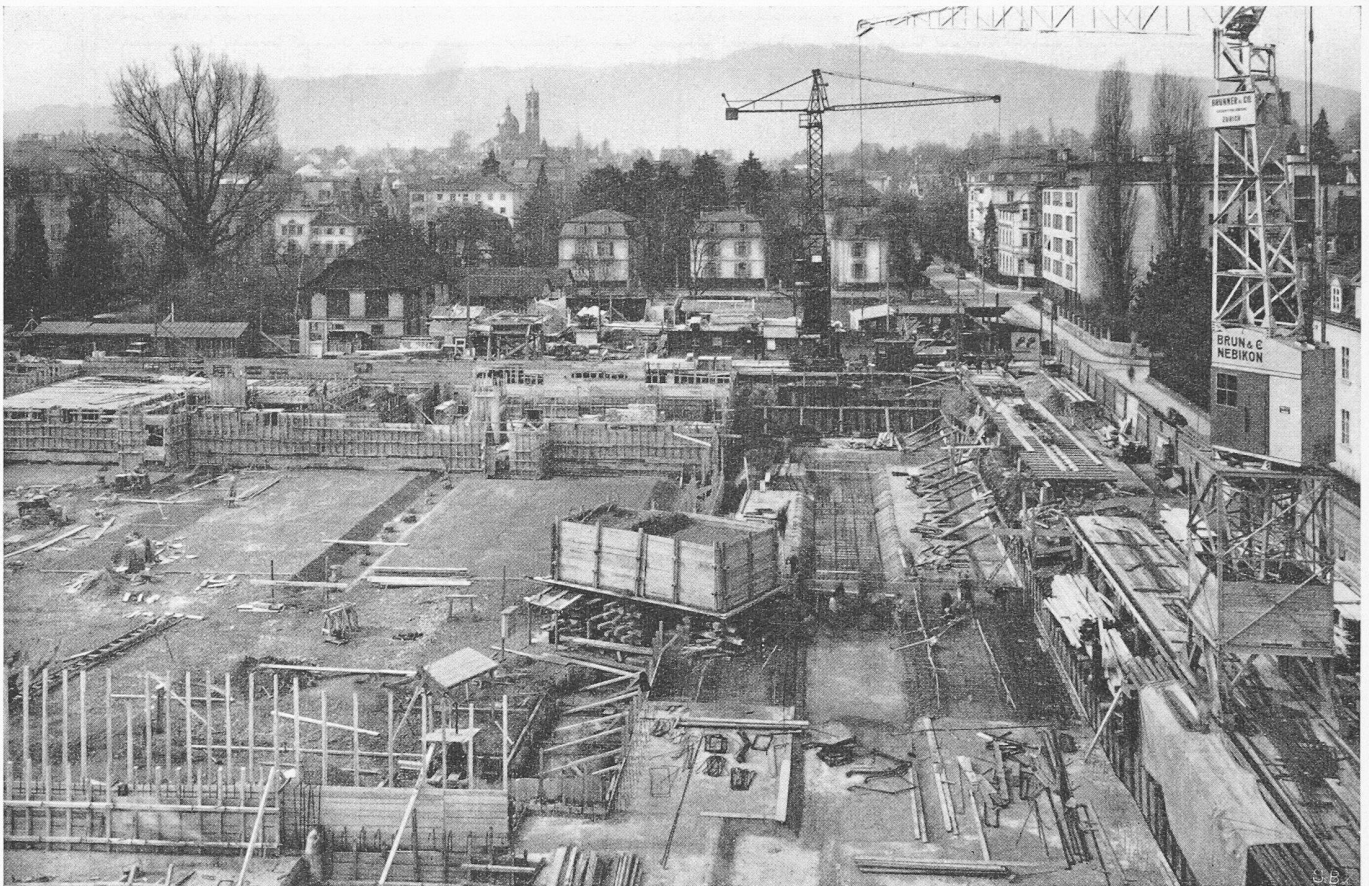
Die Baustelle am 17. März 1947, im Vordergrund Fundamente des Hauses 5, rechts Dreikönigstrasse
